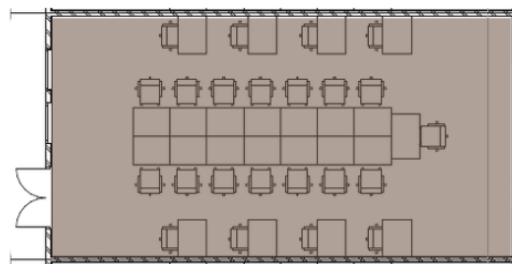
Ditutup penuh dengan Plafon pada ruang 4.09
